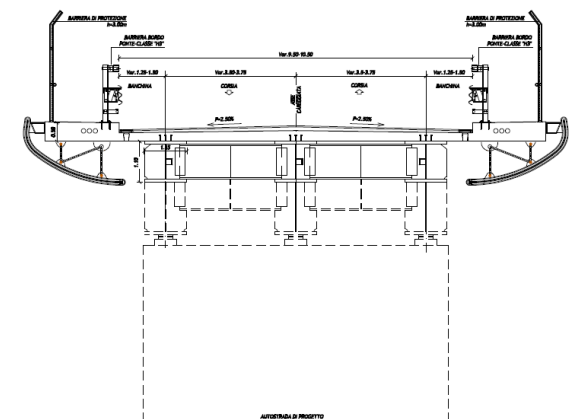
SEZIONE TIPO IMPALCATO CAVALCAVIA DI STRADA PROVINCIALE
